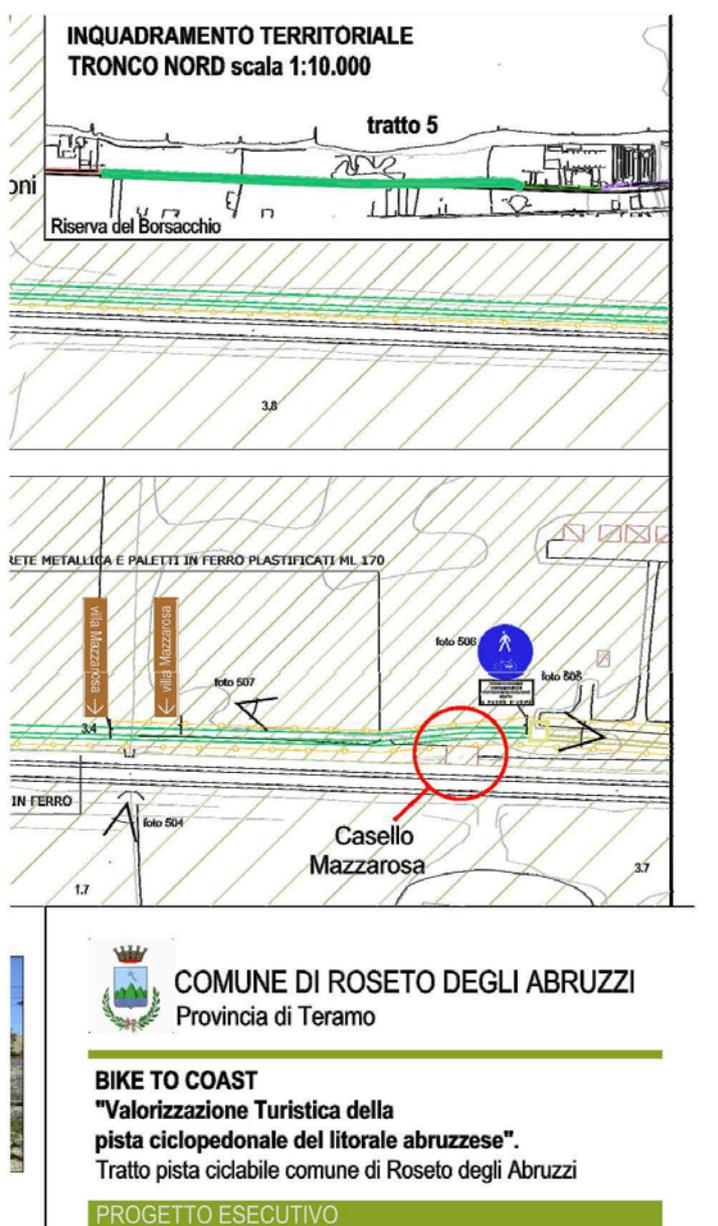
Stralcio Planimetria Progetto Esecutivo “Bike to Coast”
